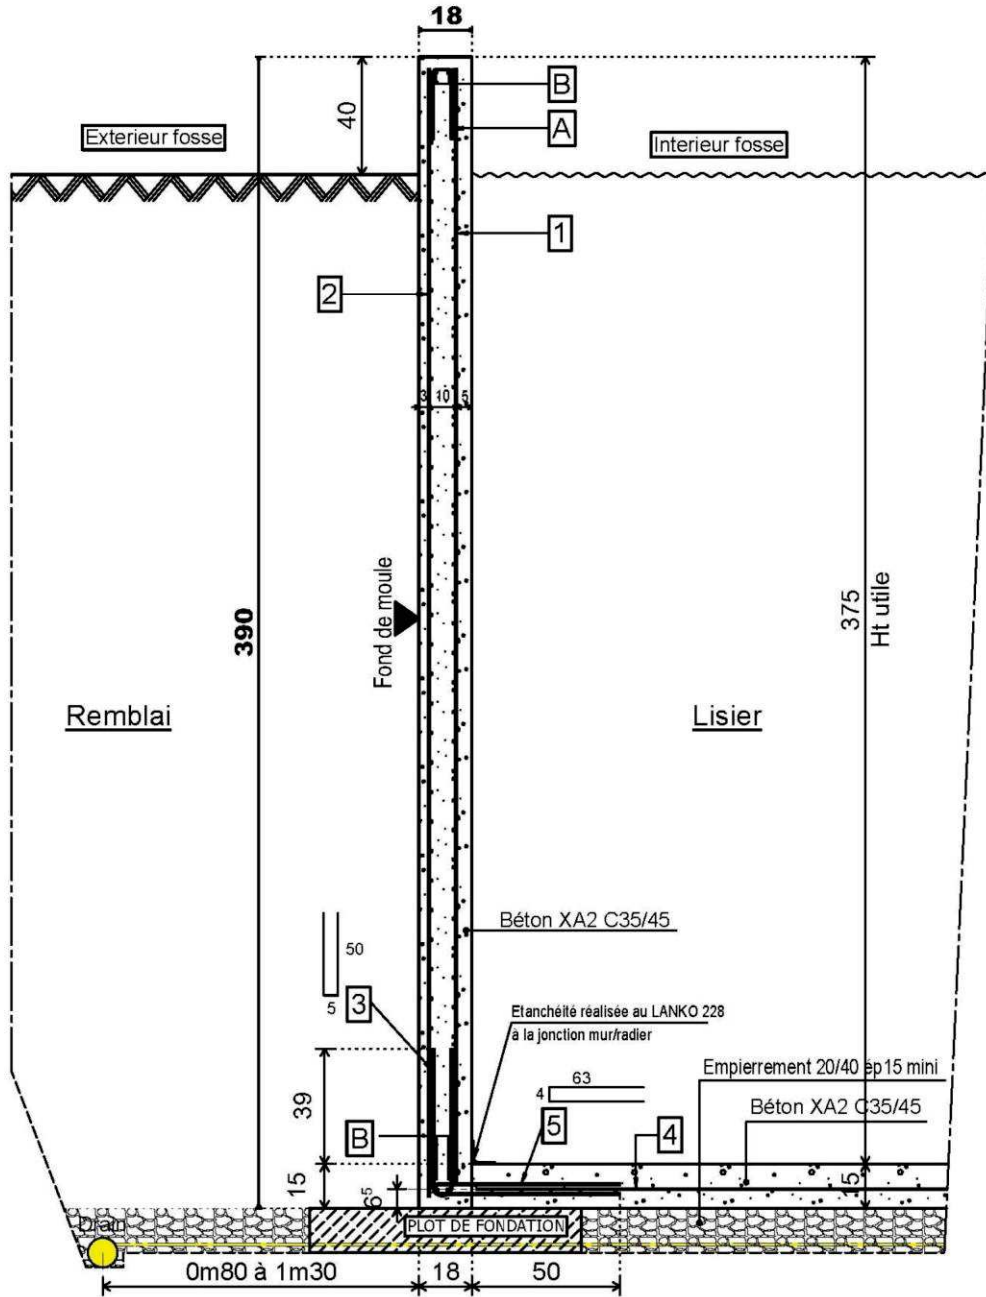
Coupe sur fosse de 2.9m face lisse coté lisier et nomenclature
